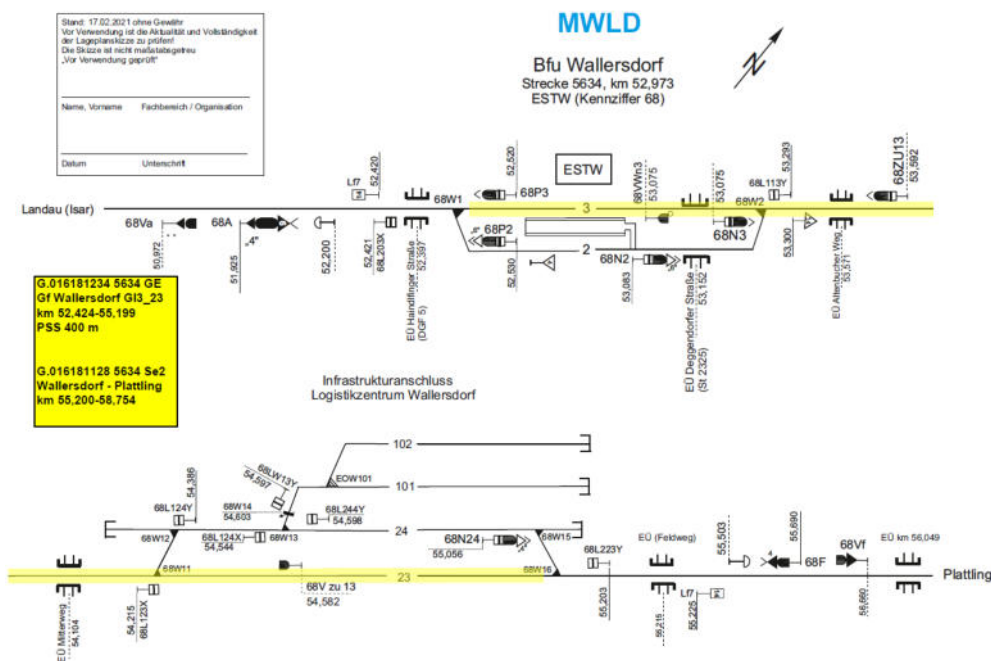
Betra-Lageplanskizze mit Umbaubereichen (DB InfraGO AG)
